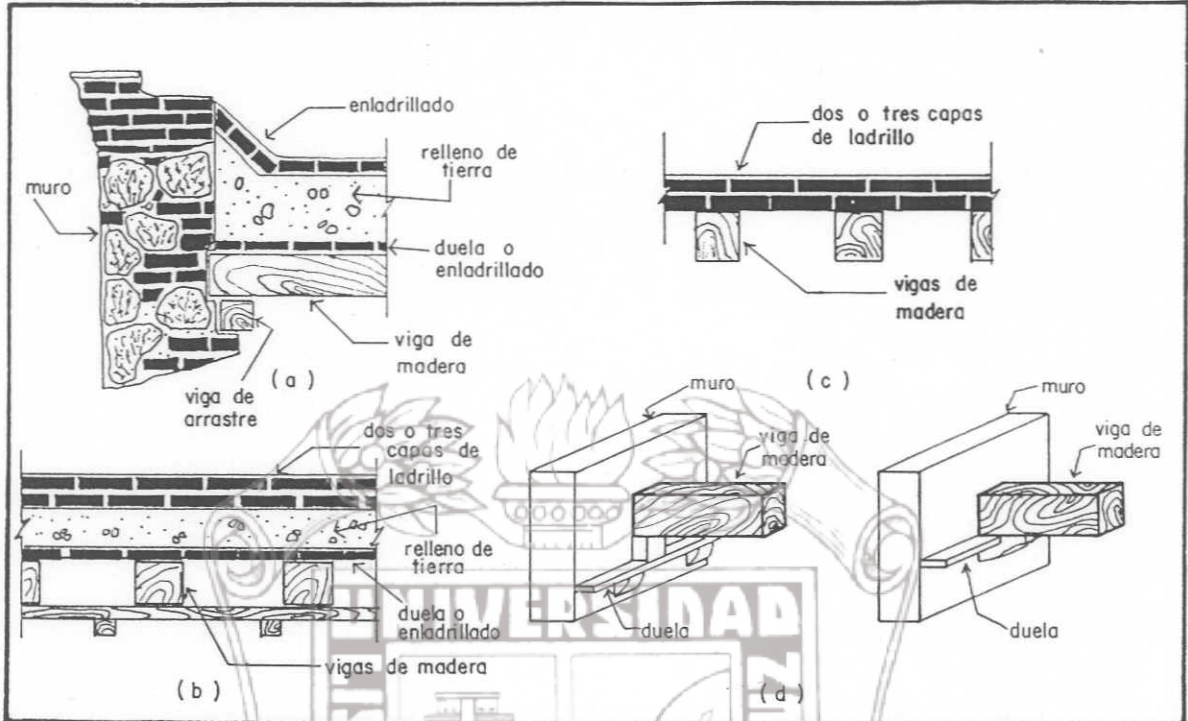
Sistema de techo y entrepiso de terrado.
